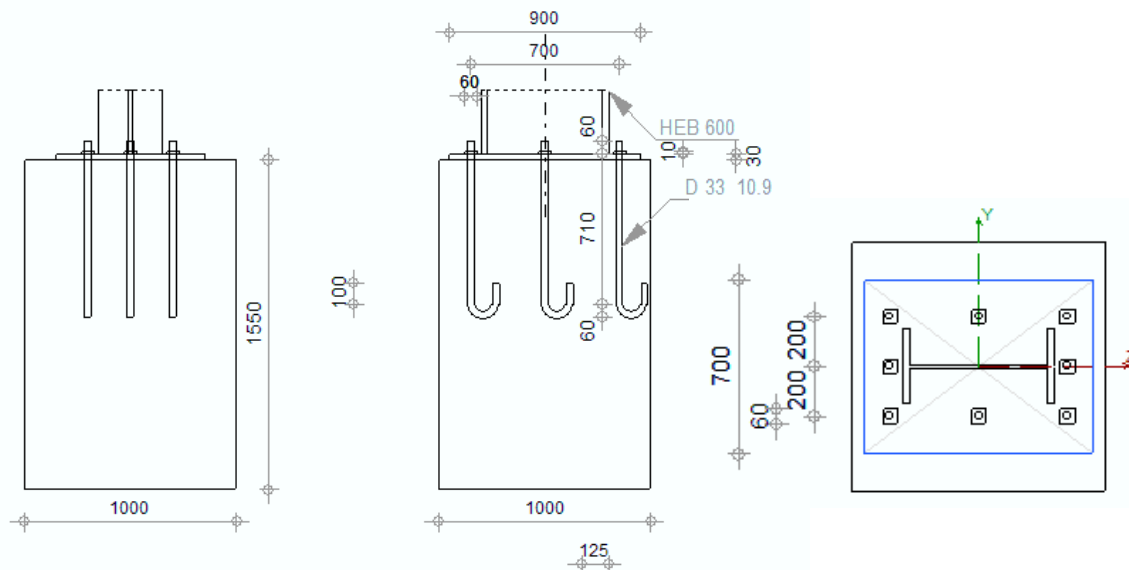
Schéma assemblage pied de poteau HEB 600 (Autodesk Robot)
